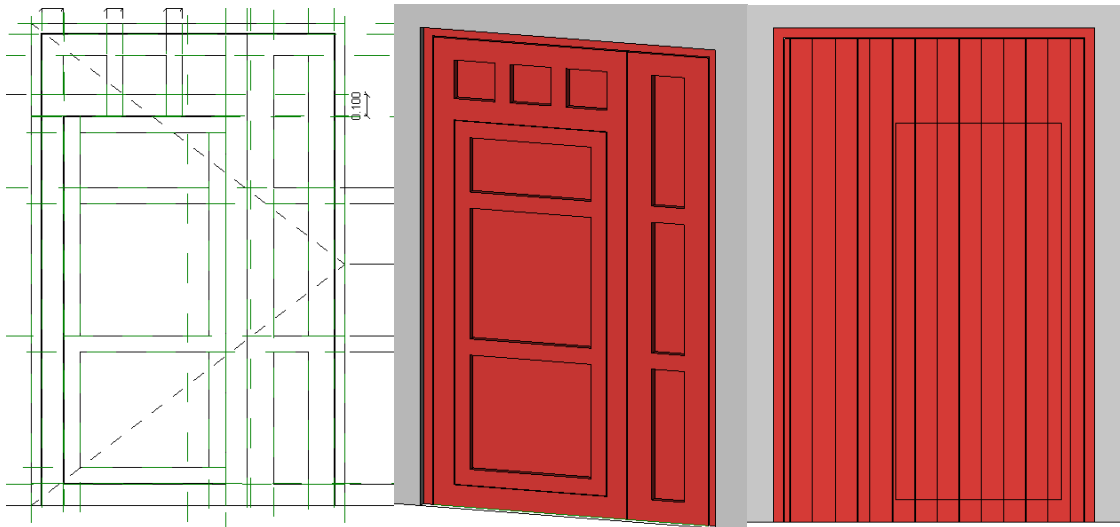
Vista de plano interior y de 3D interior y exterior de la familia puerta. Fuente: Elaboración propia.
